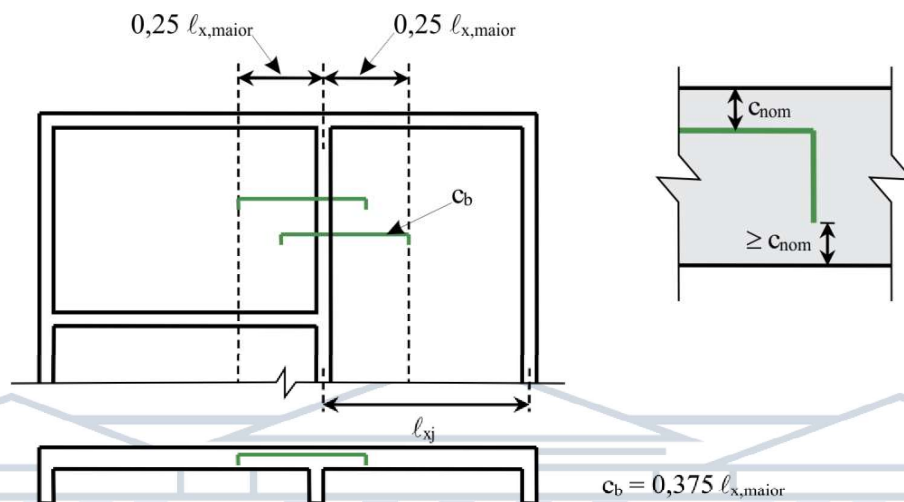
Comprimento de barras alternadas de lajes contínuas – armadura negativa
